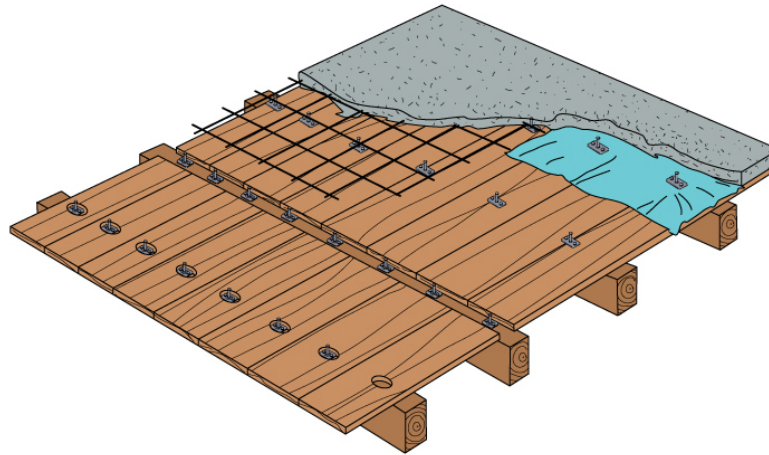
\_1 - Particolare solaio misto legno-calcestruzzo con connettori
